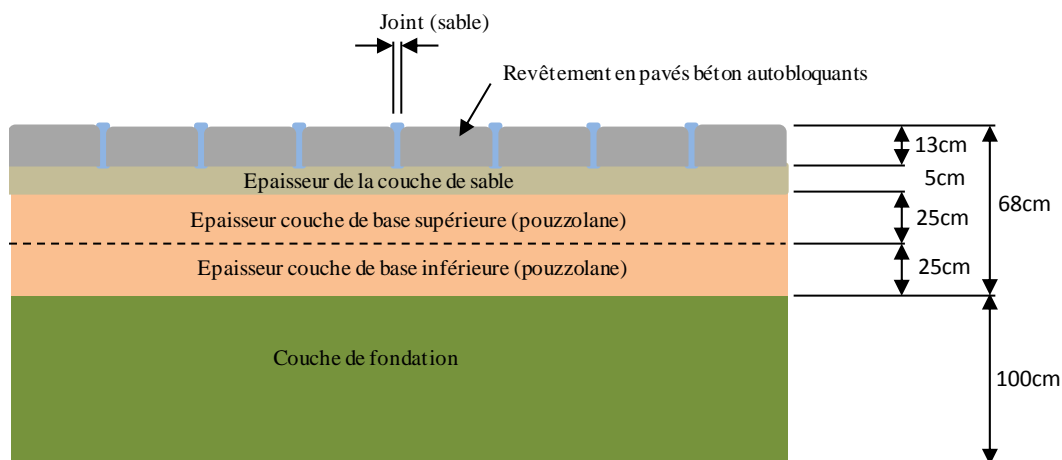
Plan de revêtement de la route concernée (proposition)
